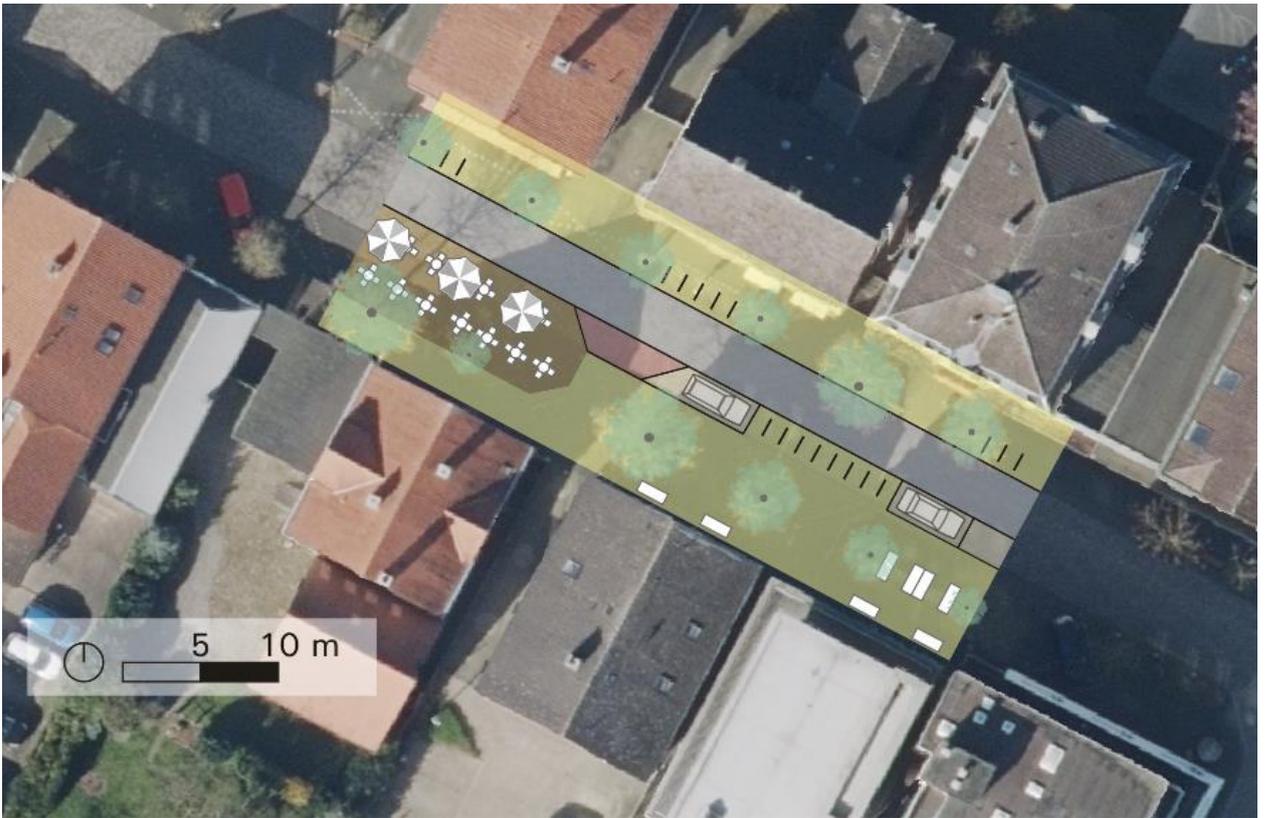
Lageplan Umgestaltungsvorschlag Bahnhofstraße (Variante I)
